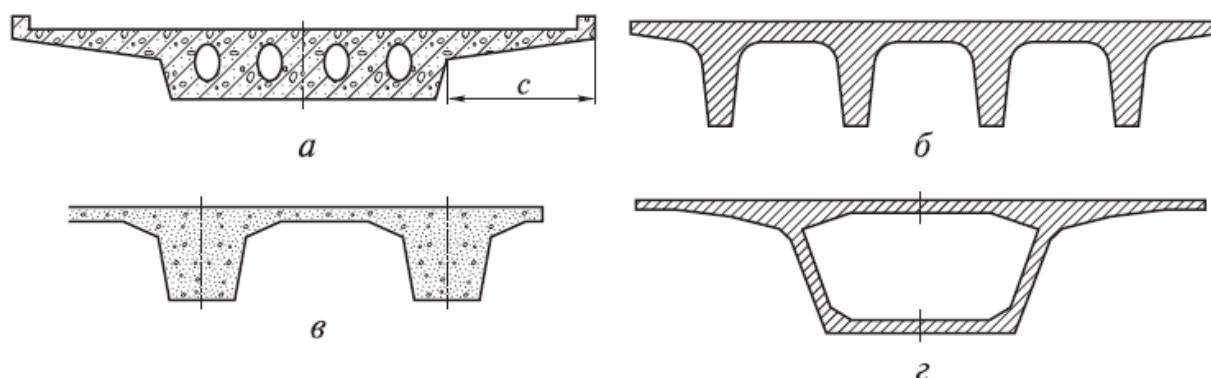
Типы поперечных сечений балочных железобетонных пролетных строений:
